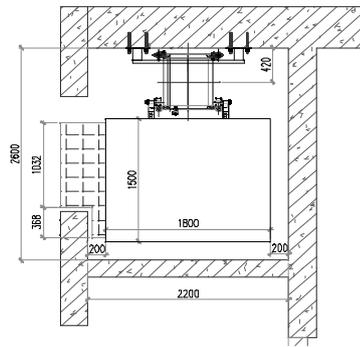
1#井道施工第1-2道施工升降机附墙锚固示意图
